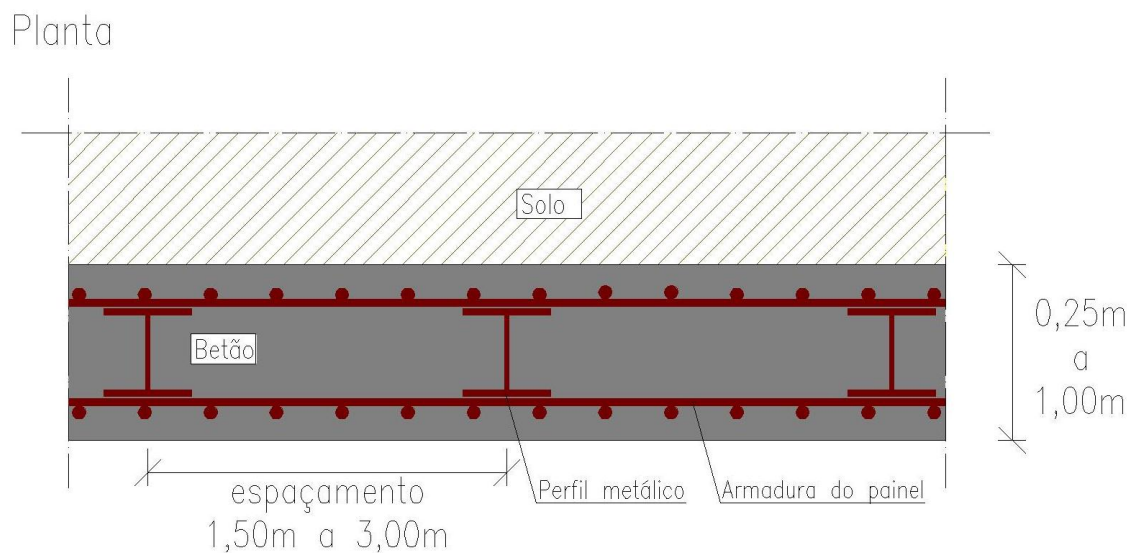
Pormenor das paredes tipo Berlim definitivo
